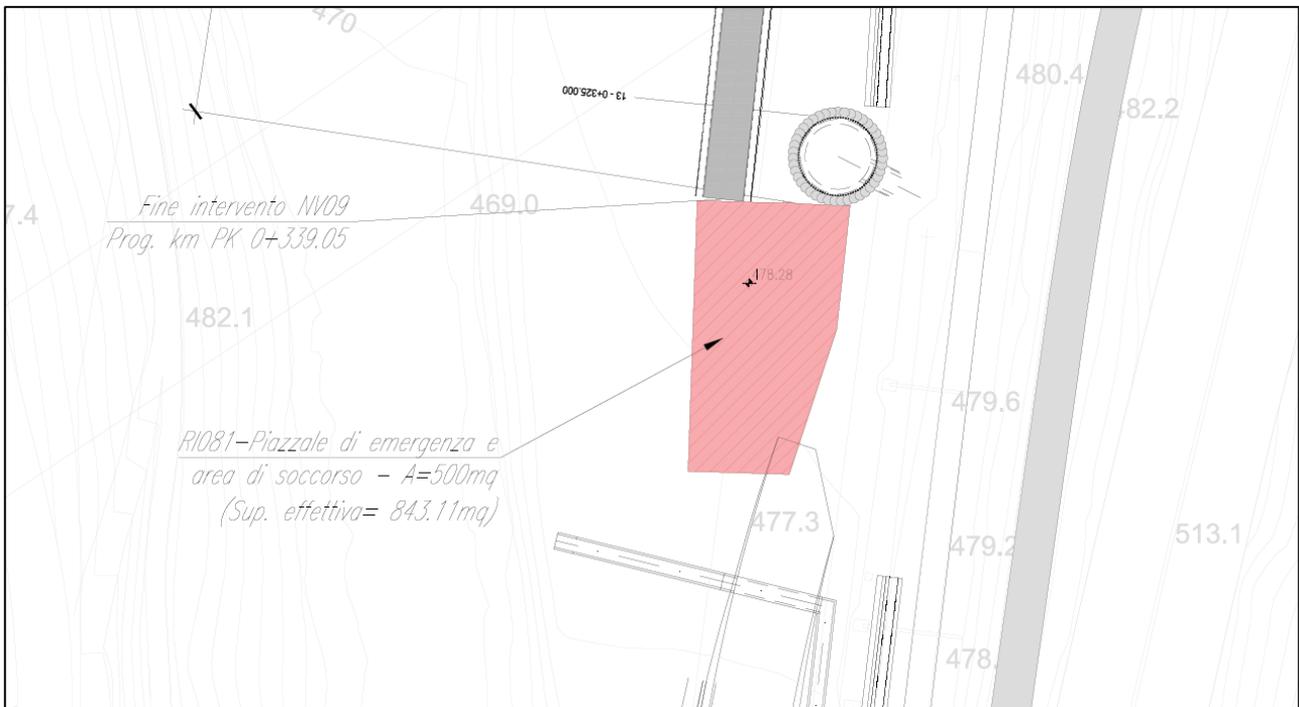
Planimetria di progetto piazzale di emergenza e area di soccorso interconnessione pari
